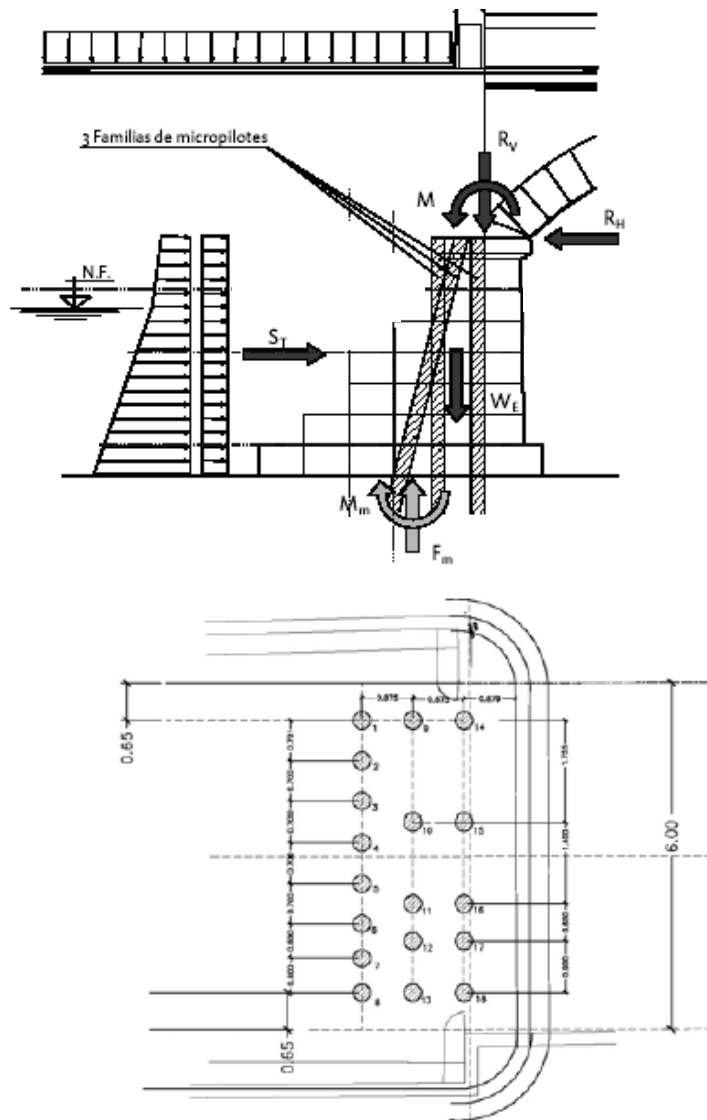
Alzado lateral y sección del refuerzo de estribos
